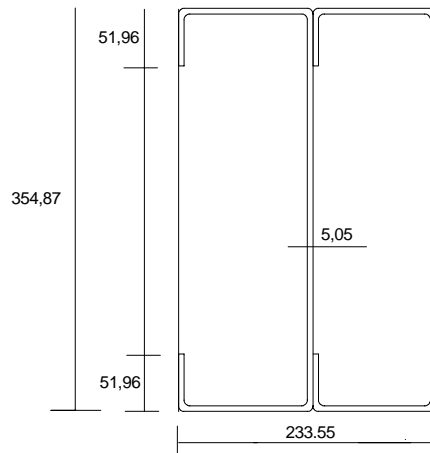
Seção Transversal da Viga VD1 (dimensões em mm)
